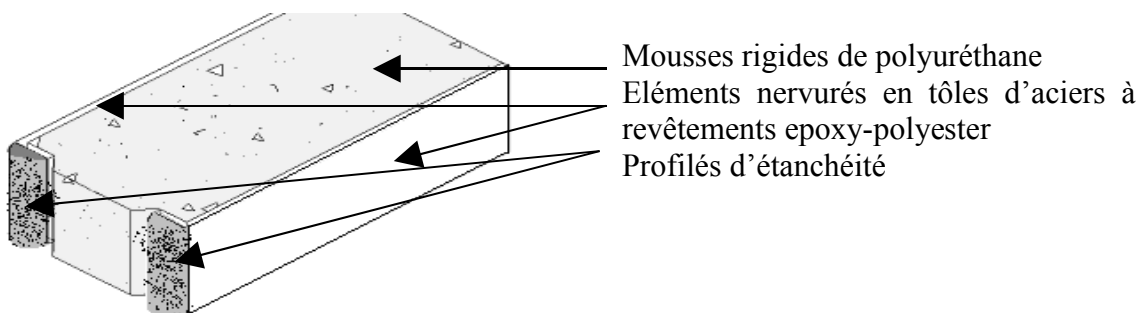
Coupe de panneaux isolant en PUR
